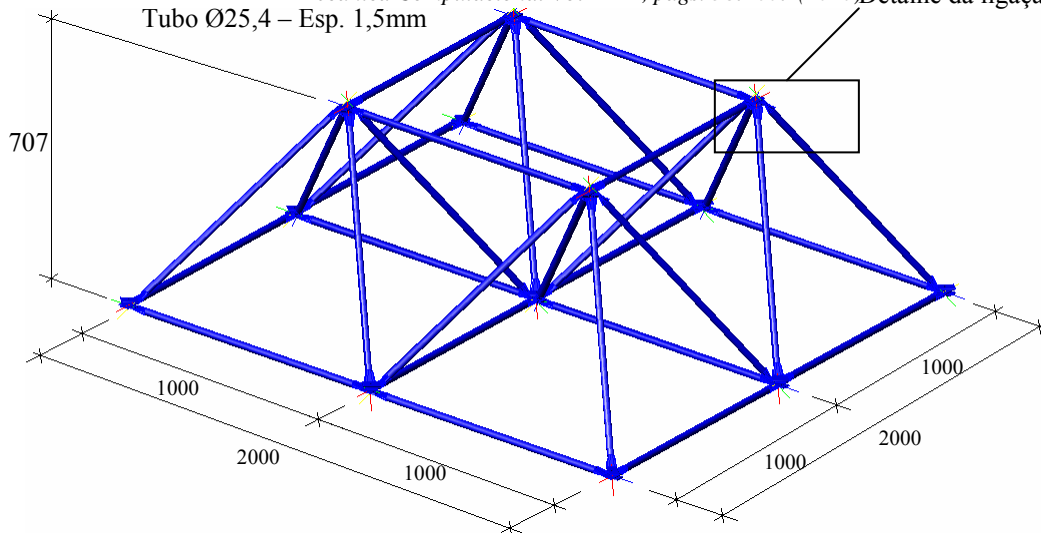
Modelo da estrutura treliçada tridimensional adotada, cotas em milímetro
